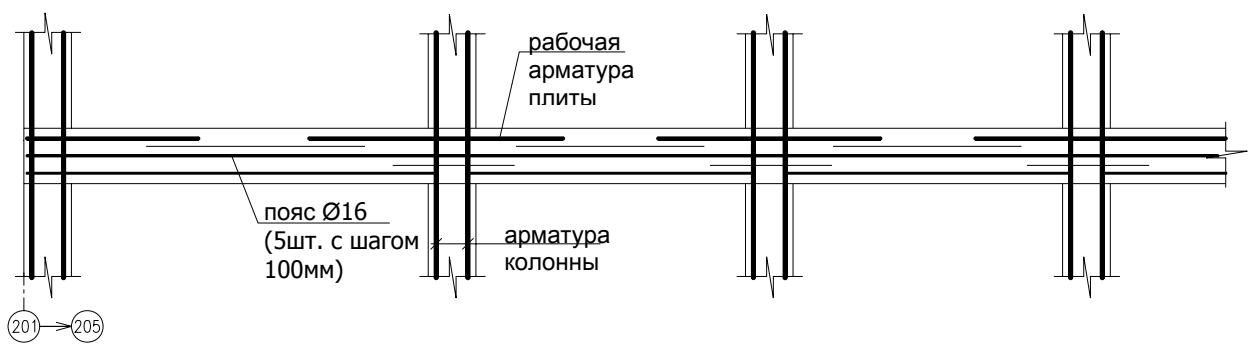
Усиление горизонтальными связями в плите перекрытия по методу СК.
